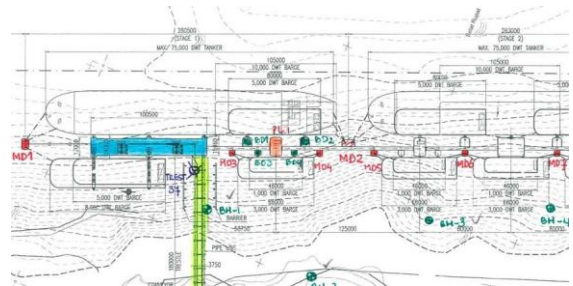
Tampak depan Jetty utama (Engineering sketch)
